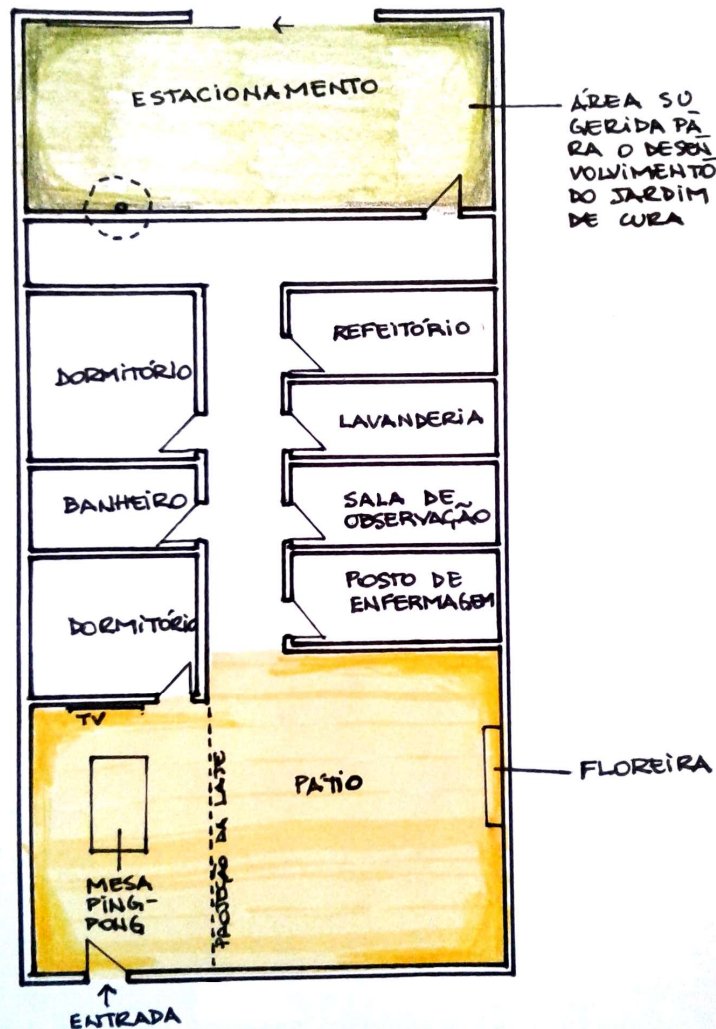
Planta baixa da área do térreo com indicação de local para implantação do jardim de cura.
